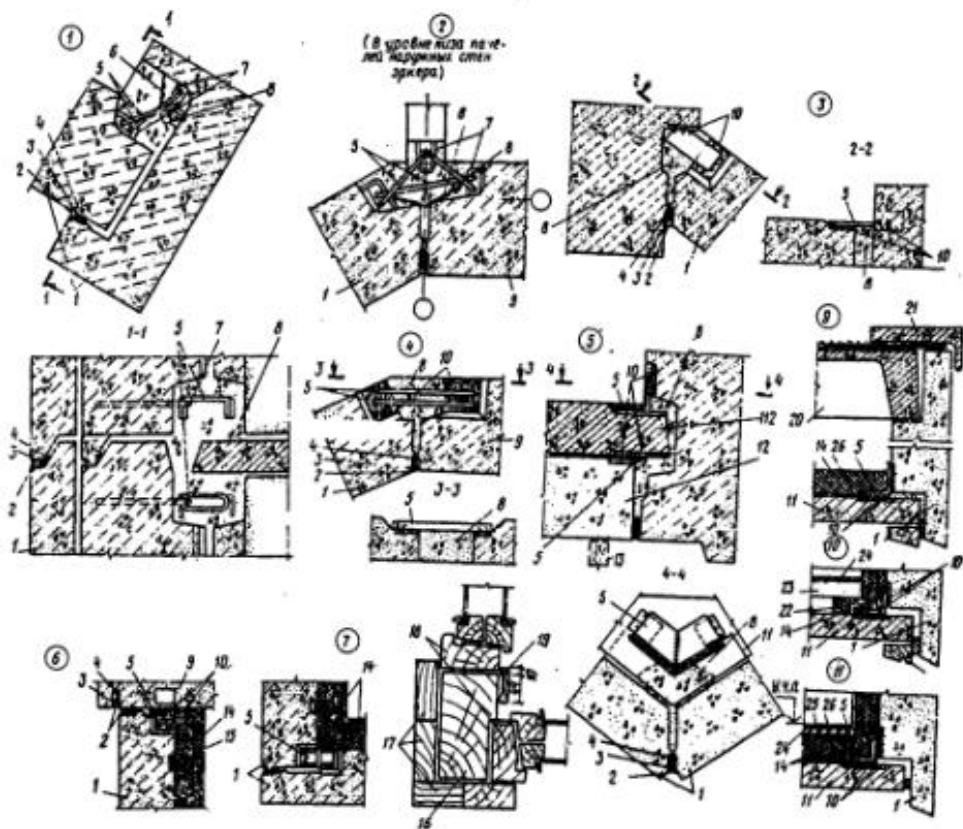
Узлы сопряжений элементов эркера: 1 - наружная стенная панель эркера; 2 - цементный раствор; 3 - герметизирующая мастика; 4 - упругая прокладка; 5 - стальные связи панелей; 6 - оклеечная гидроизоляция; 7 - петлевой арматурный выпуск; 8 - бетон замоноличивания; 9 - наружная стенная панель; 10 - закладная металлическая деталь; 11 - панель перекрытия; 12 - утепляющая керамзитобетонная плита; 13 - временная деревянная подпорка (до установки панели перекрытия); 14 - утеплитель; 15 - деревянная рейка в панели эркера; 16 - стойка; 17 - обрамляющие доски; 18 - оконная коробка; 19 - наличник; 20 - плита покрытия; 21 - паралетный камень; 22 - плита древесноволокнистая мягкая; 23 - плита основания пола; 24 - линолеум; 25 - полутвердая древесноволокнистая плита; 26 - пароизоляционный слой
